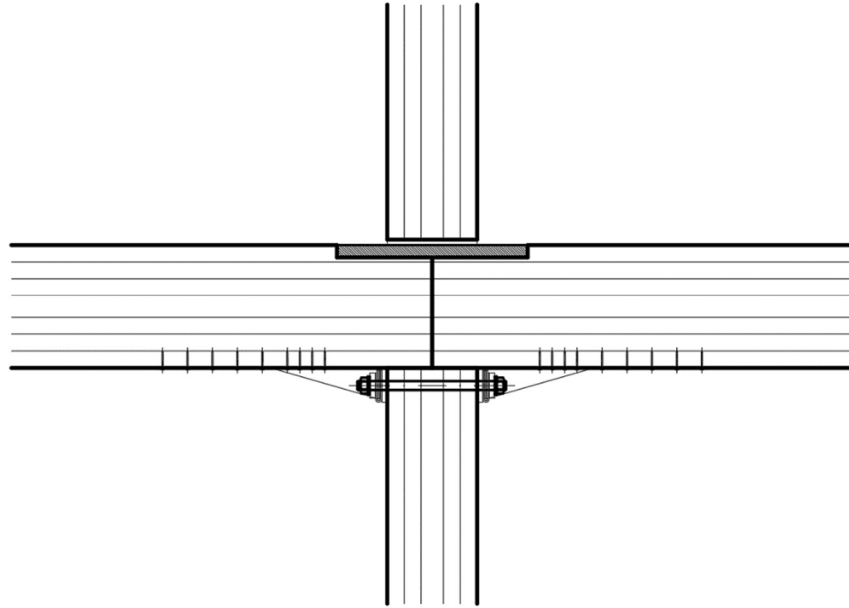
bron : Tall Timber Buildings : Applications of Solid Timber Construction in Multistory Buildings – M. Wells - 2011
